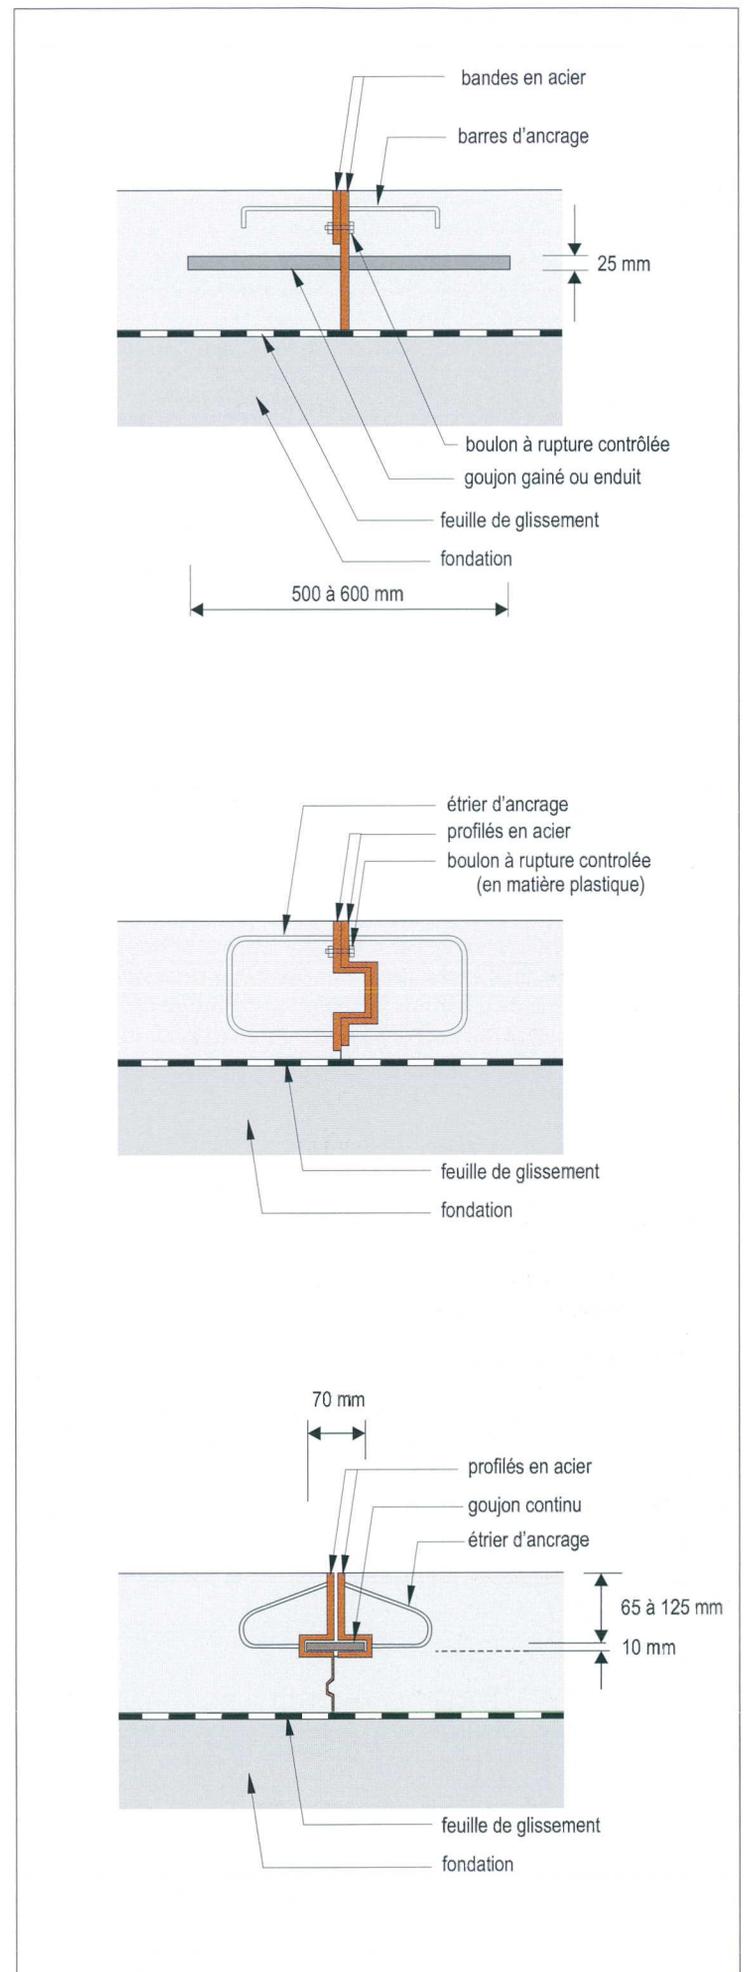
Exemples de joint de structure – Profilé de joint en acier
